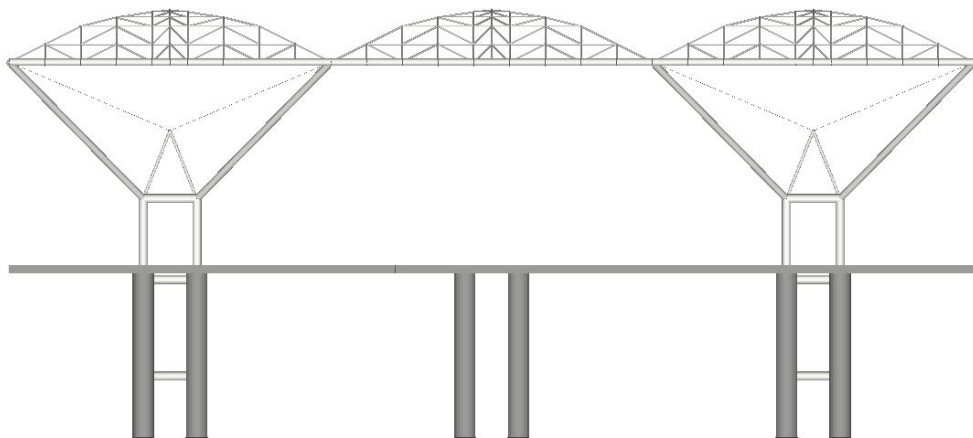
Modelo 3D | Alzado de los dos tipos de estructura
